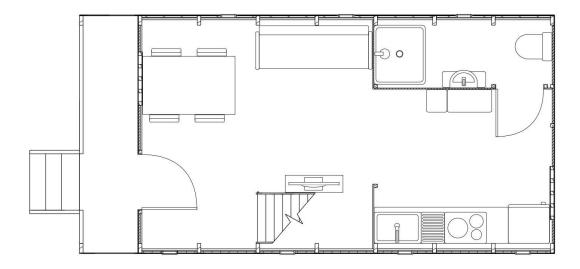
plano planta baja amueblada Néo Oikos Fuente: elaboración propia
